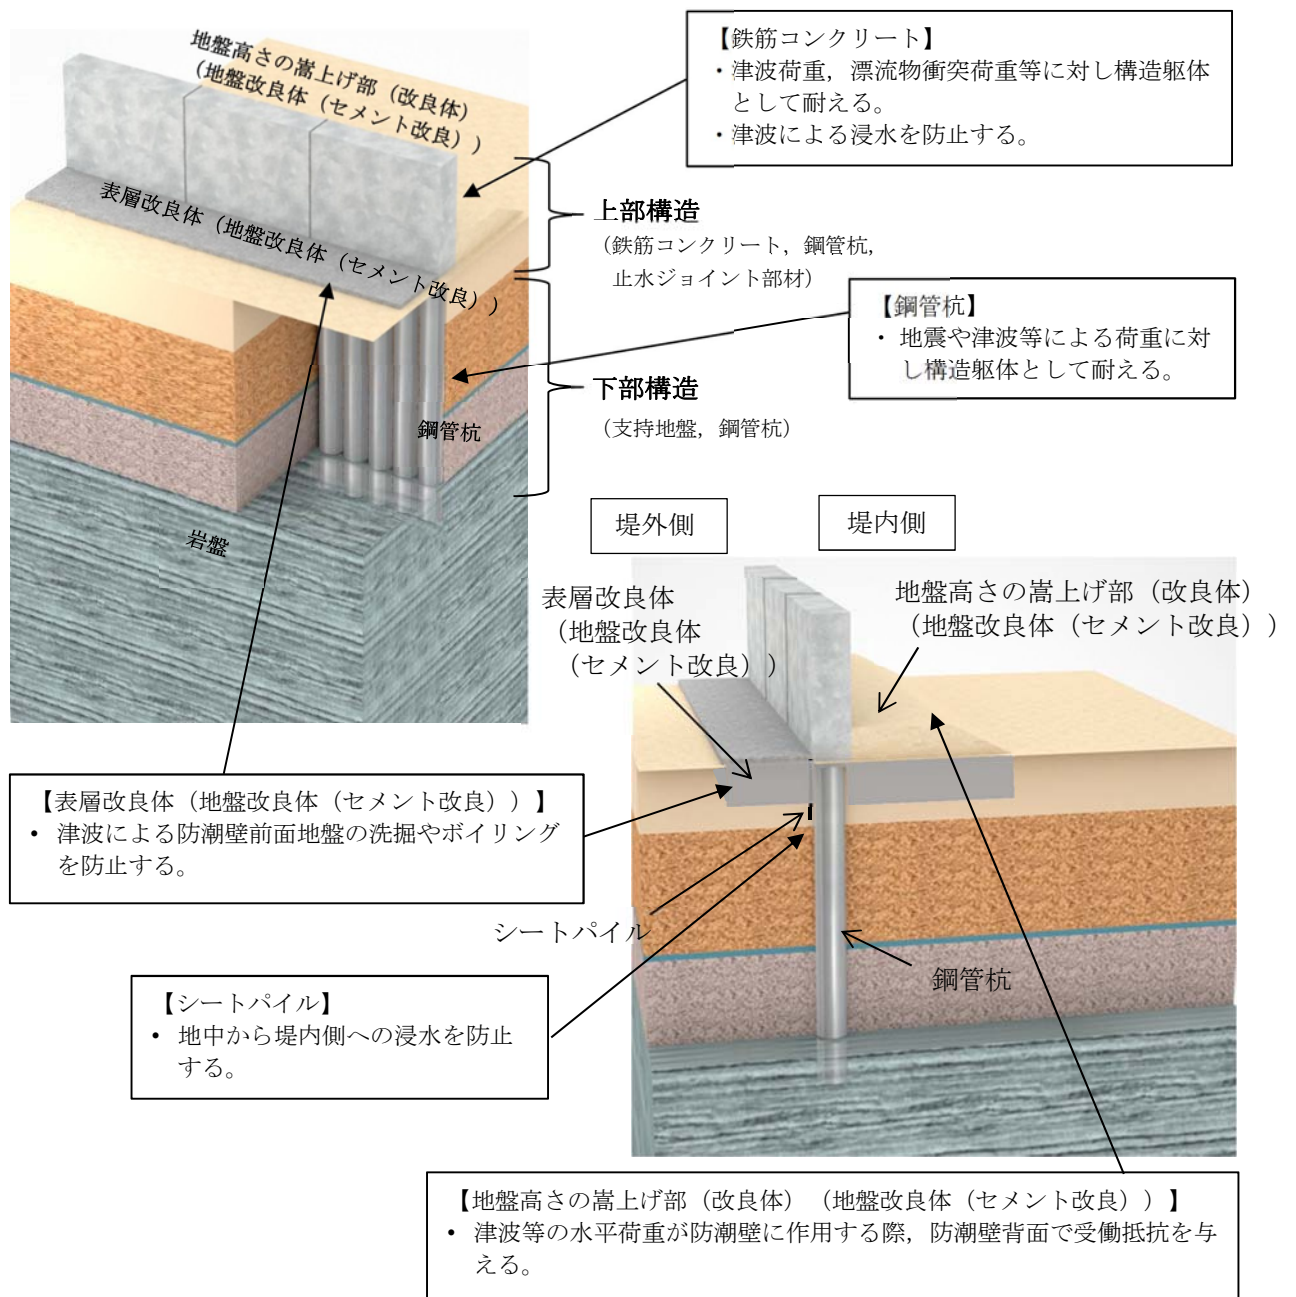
(2) 鋼管杭鉄筋コンクリート防潮壁の構造概要図 (2/2)
